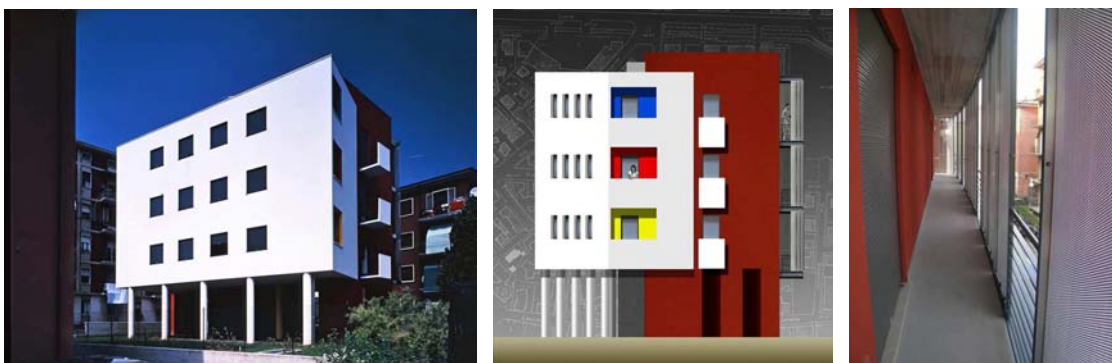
Casa per lavoratori immigrati M. Pettoello, Verona, fotografie
